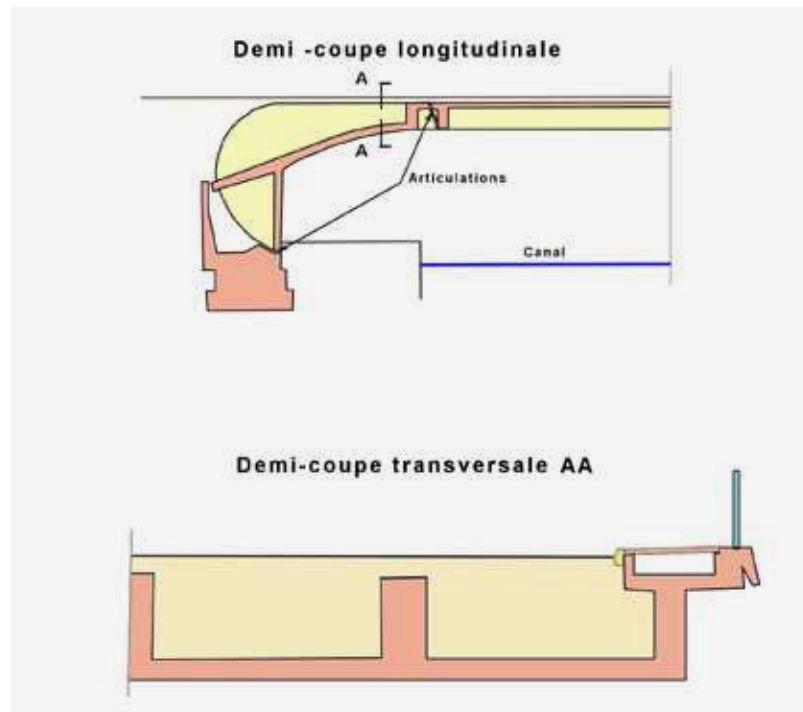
demi-coupe longitudinale et demi coupe transversale du pont de La Neuville
